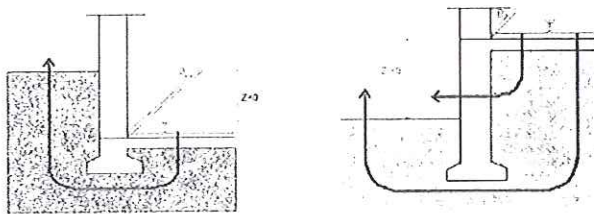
Pavimento em contacto com o terreno sem isolante térmico.
